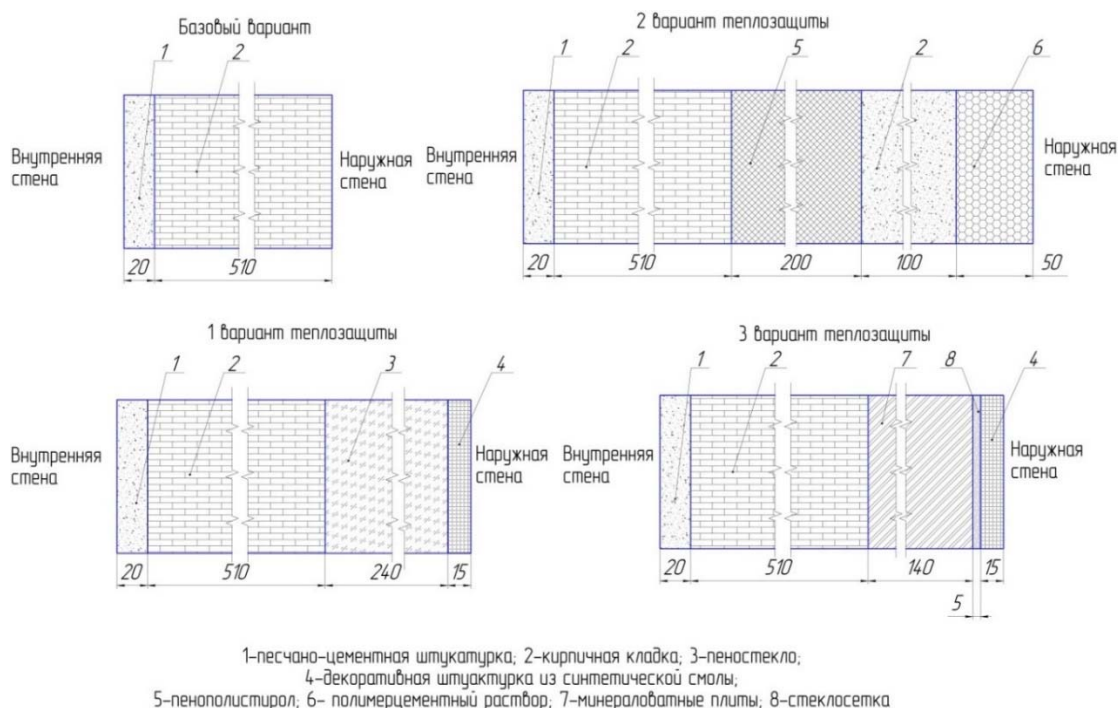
Схемы строительных конструкций наружных стен школьного здания
